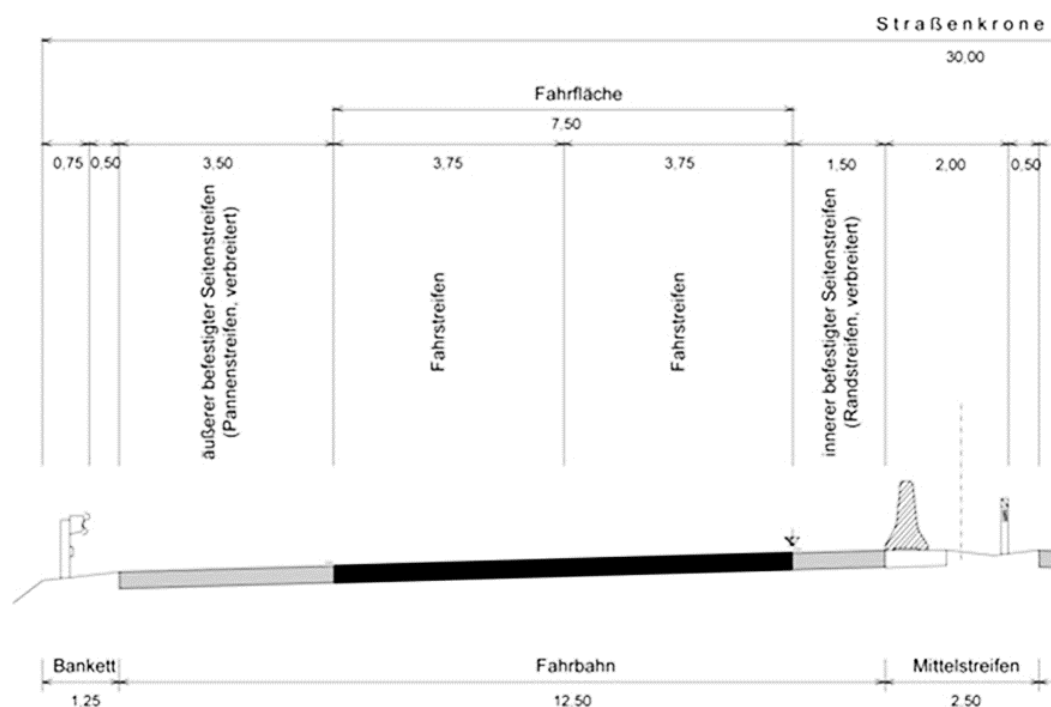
RVS 03.03.31: Querschnitt einer Strasse mit zweistreifigen Richtungsfahrbahnen für eine Verkehrsführung 4+0, Bsp. Österreich
